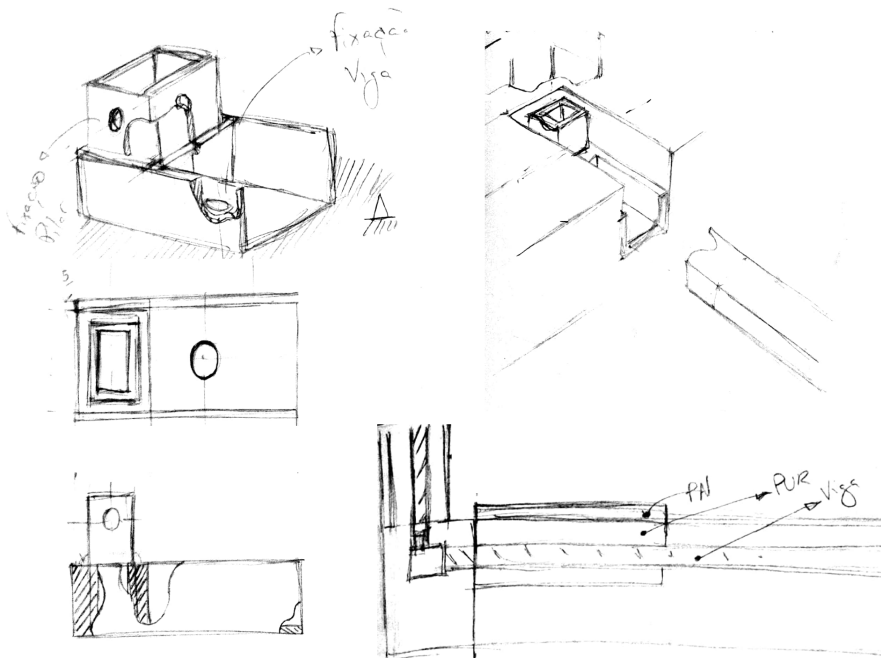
Primeiro conceito para o encaixe da viga do chão com o pilar da parede.
